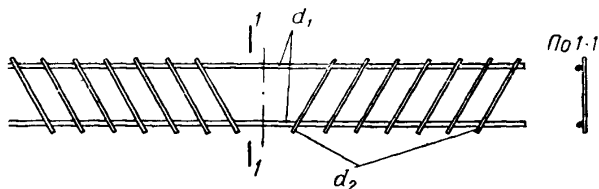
Тип сварного каркаса балок с наклонным расположением поперечных стержней
